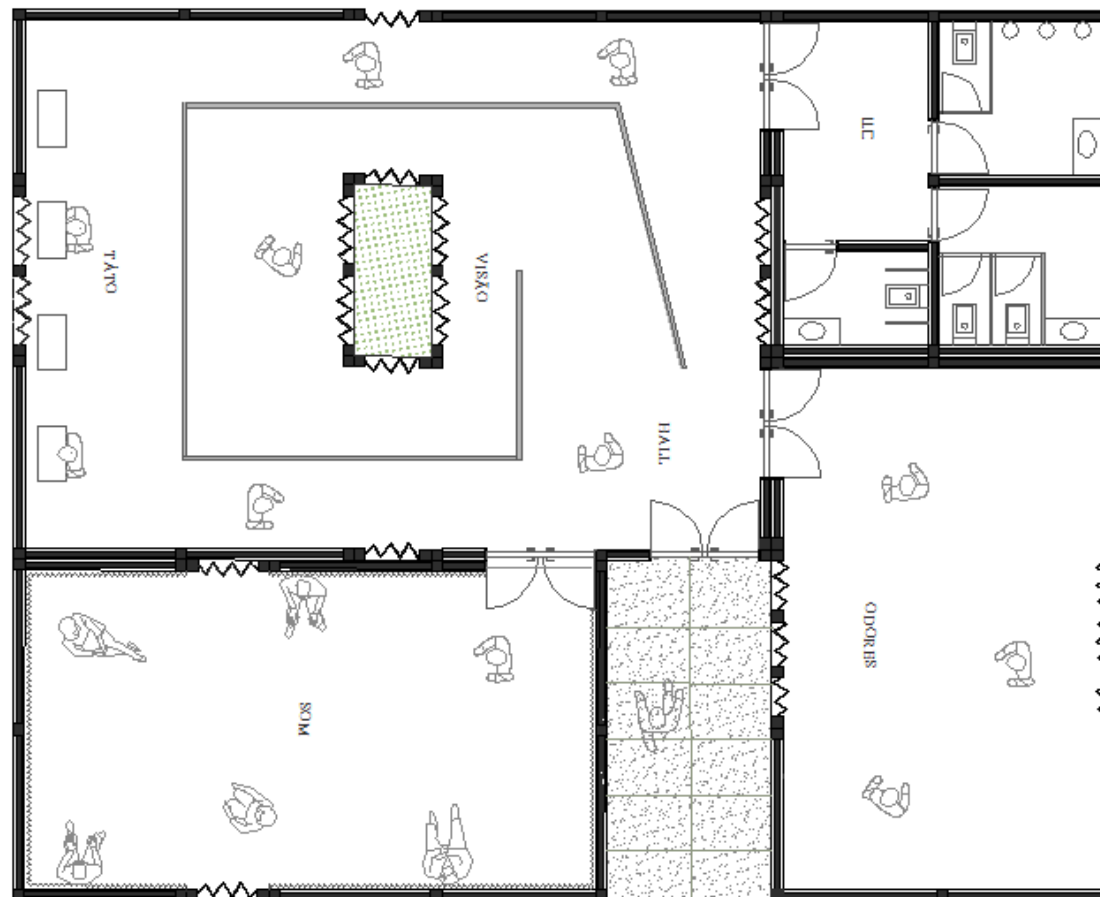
Planta do Piso 0. Escala 1 | 100.
